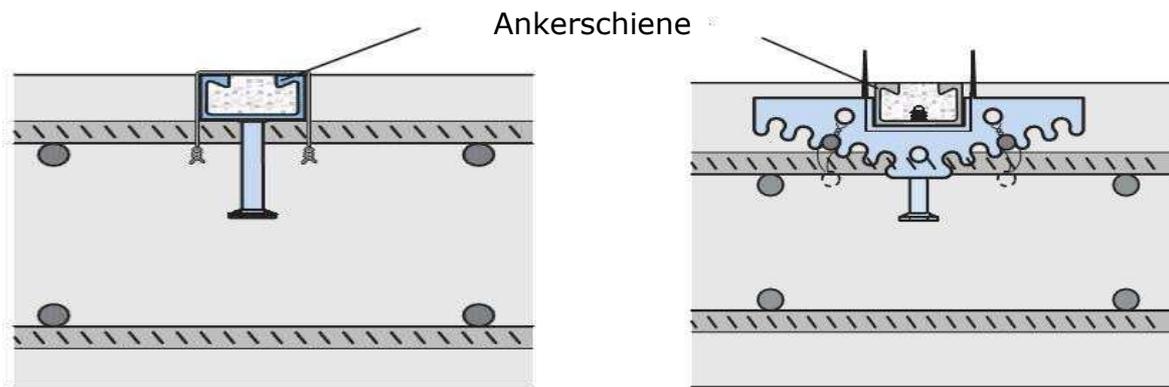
Befestigung direkt an der Bewehrung (li.) und mit Clip-System an der Bewehrung (re.) nach [14]
